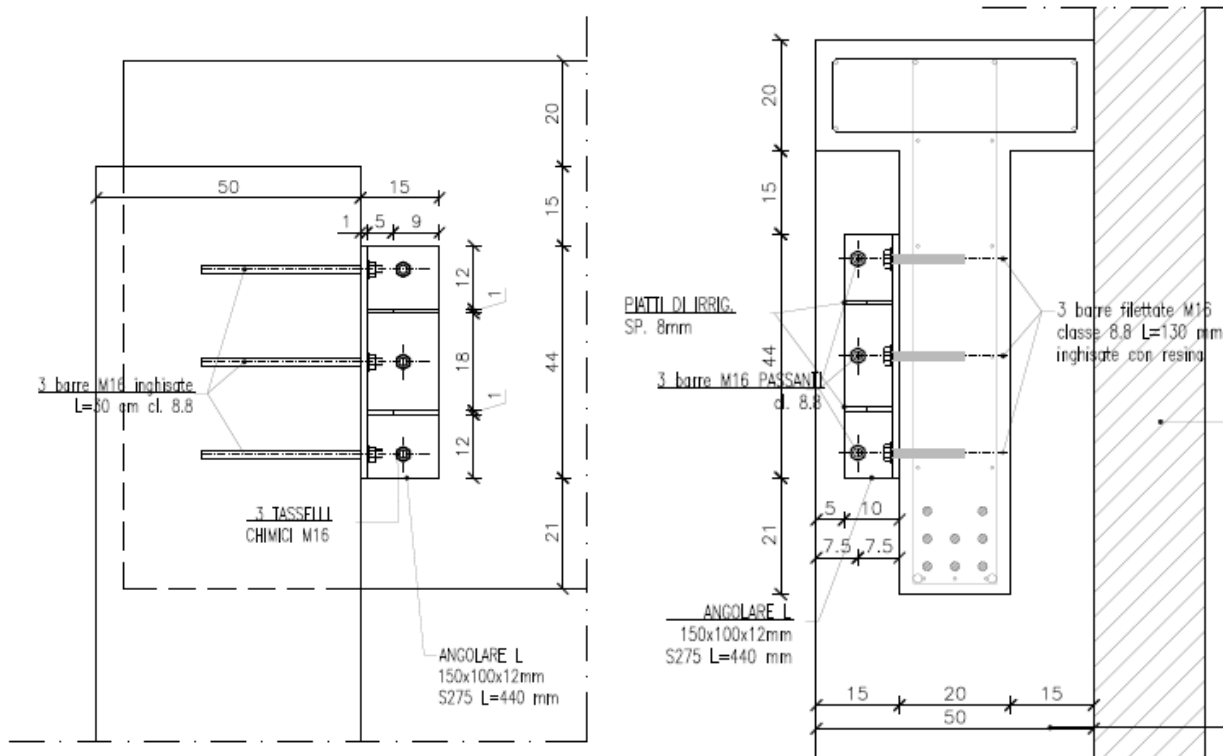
particolare P1 della connessione trave-pilastro in assenza di controvento
